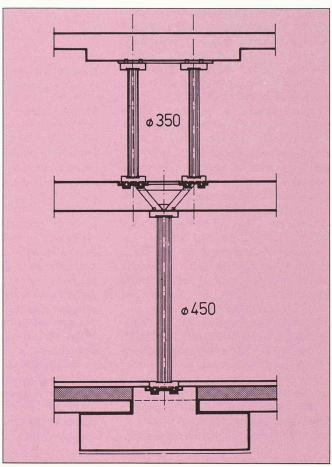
Trémies d'escaliers : coupe montrant la disposition de colonnes doubles au niveau supérieur.
